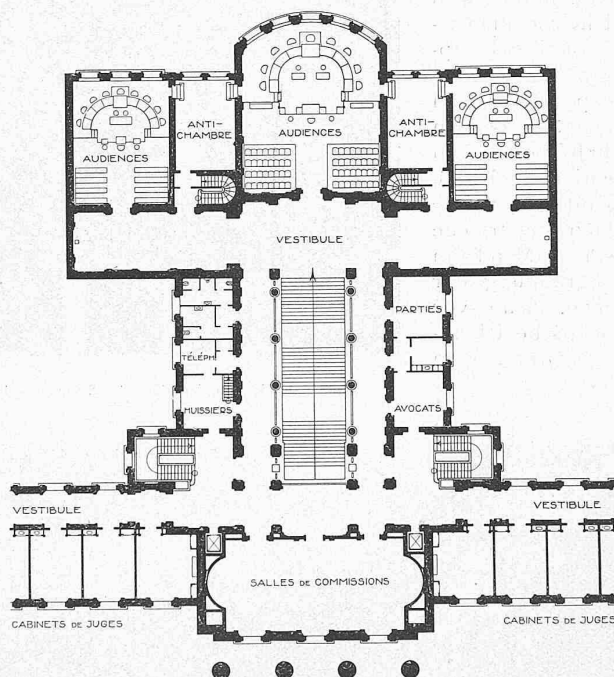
und 3 Grundrisse von Erdgeschoss und I. Stock (Mittelbau), Abb. 4 oben Hauptfassade 1:600 zum Neubau des Schweiz. Bundesgerichts in Lausanne.
